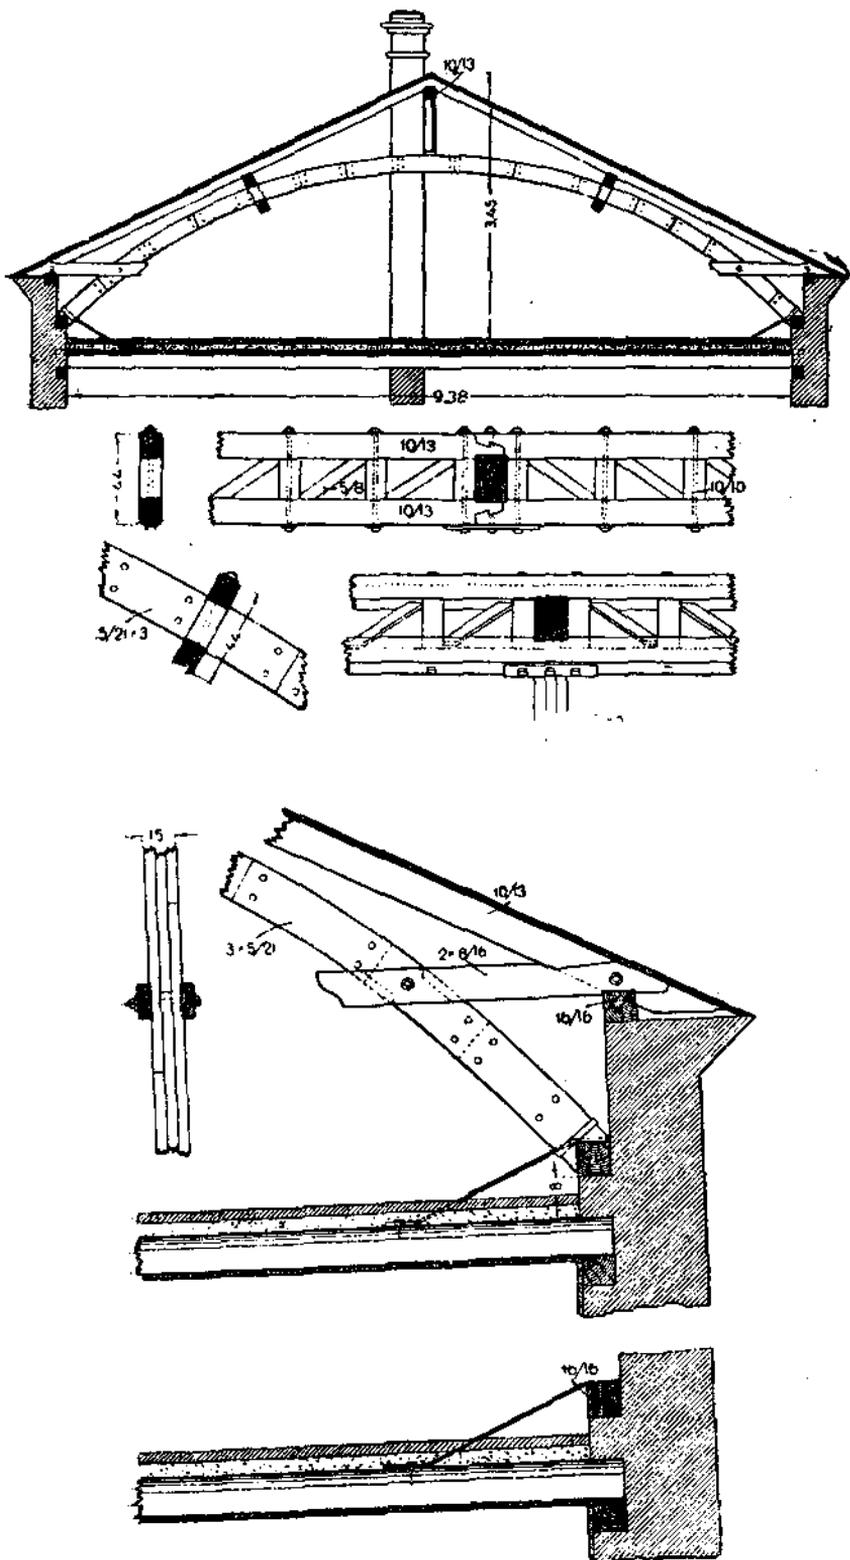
арочное перекрытие с дугой Делорма пролетом 16 м; дуга довольно пологая, вследствие чего оказалось возможным поперечные связи уложить непосредственно на дугу. Дуга опирается в деревянные брусья, установленные вертикально к наружным стенам, для распределения горизонтального распора на большую площадь каменных
